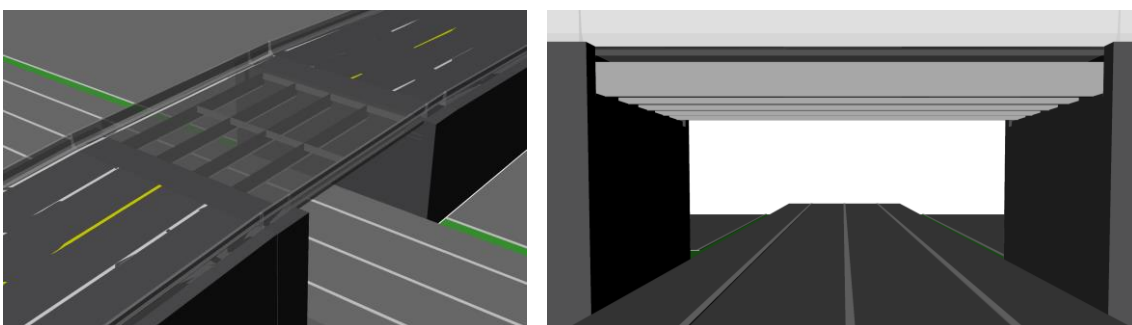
Reproducción mediante Rhino de un paso superior de vigas metálicas con losa de hormigón armado.
